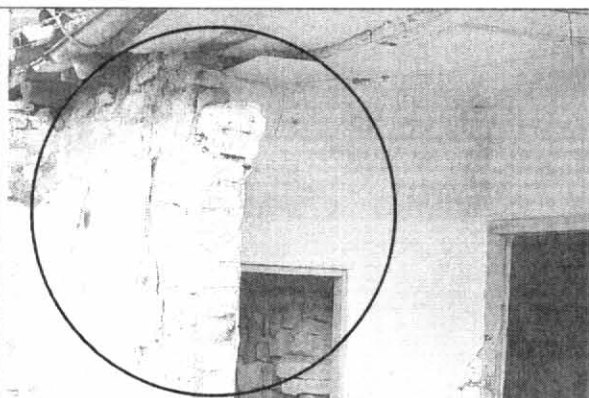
Muros parcialmente colapsados con dislocación de piezas en mampostería.
